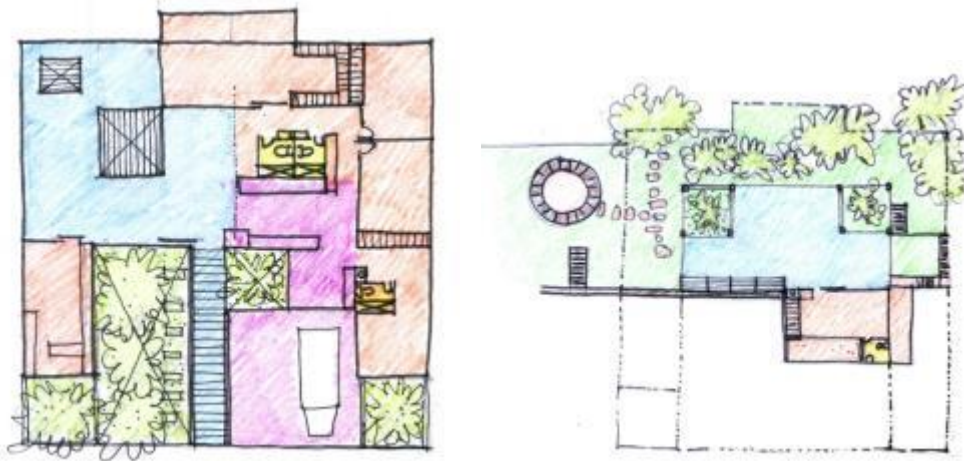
Planta de acceso y planta terraza del Tarantín. Indicando los espacios públicos, privados y de servicio. Croquis realizado por el autor.
